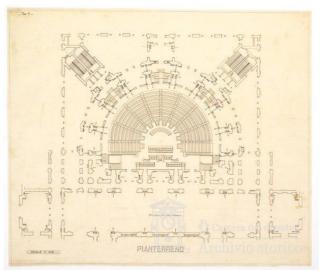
Ernesto Basile, pianta dell'aula di Montecitorio. © Camera dei Deputati, Archivio storico.
